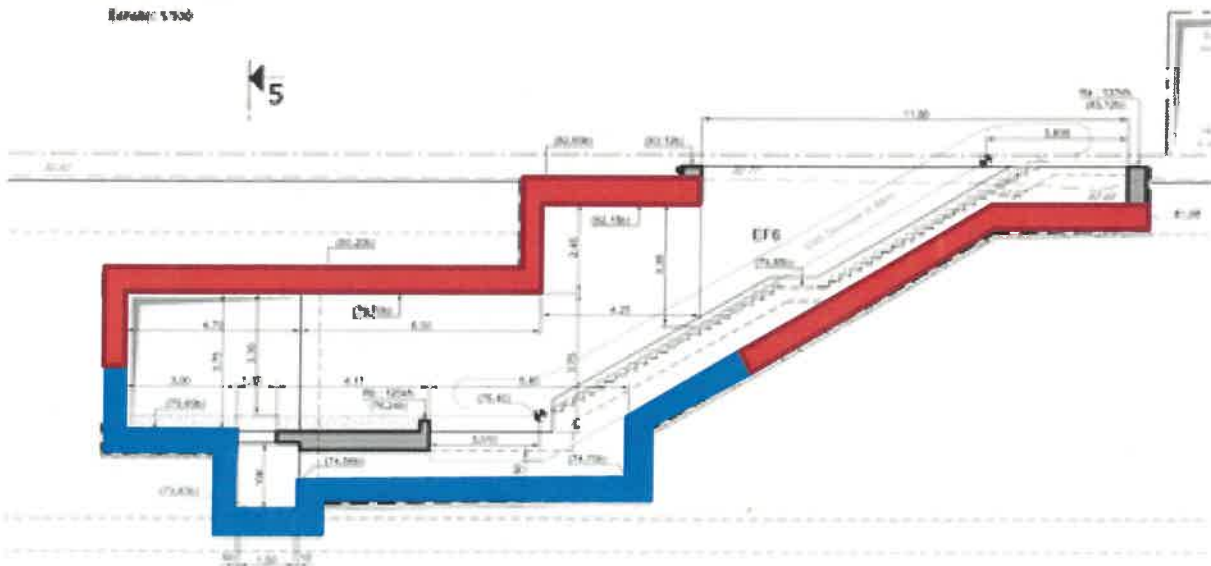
Zonage des efforts horizontaux dans les planchers et dans les voiles de sortie secondaire
